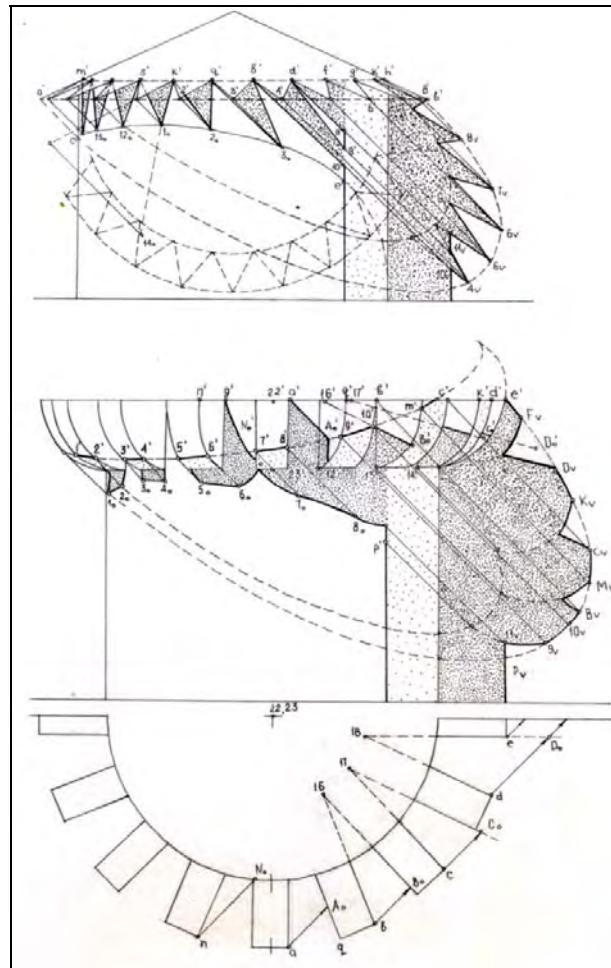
Тени зубчатого круглого карниза, имеющего значительное количество точек, без использования плана
